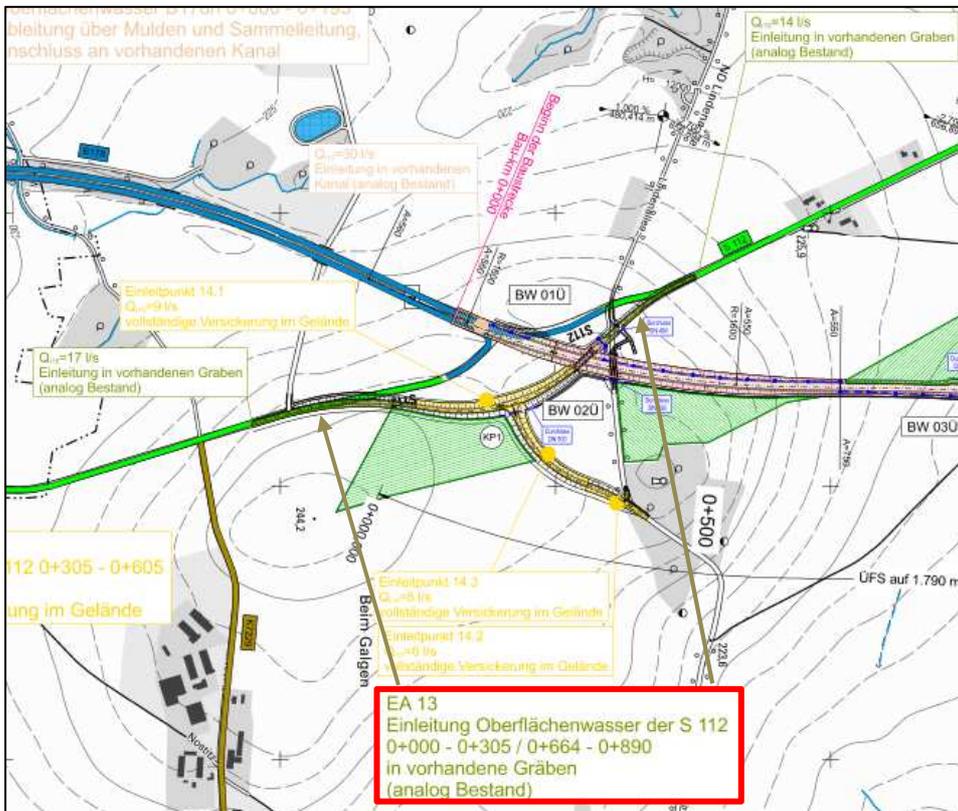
Entwässerungsabschnitt EA 13 (Ausschnitt aus Übersichtslageplan Entwässerung, Unterlage 8)
